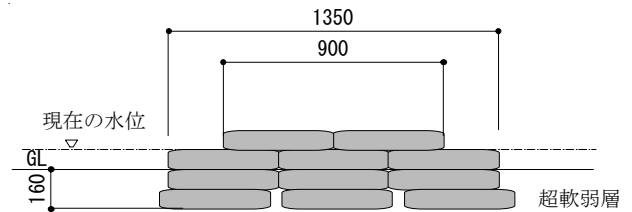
沼地載荷試験での土のう配置図 (寸法 : mm)
